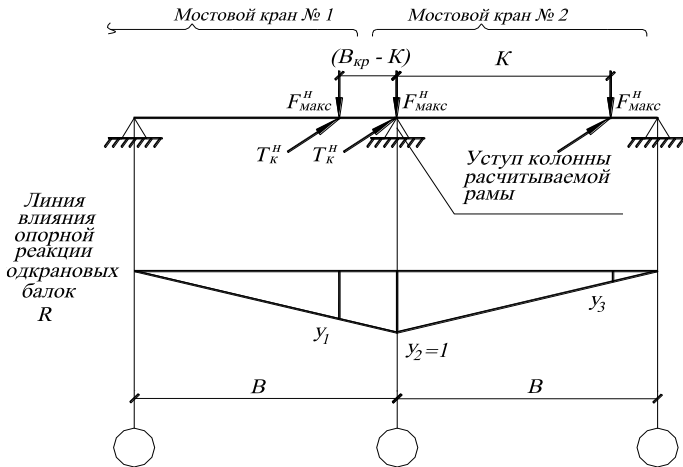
Схема для определения нагрузки от мостовых кранов на поперечную раму промышленного здания
